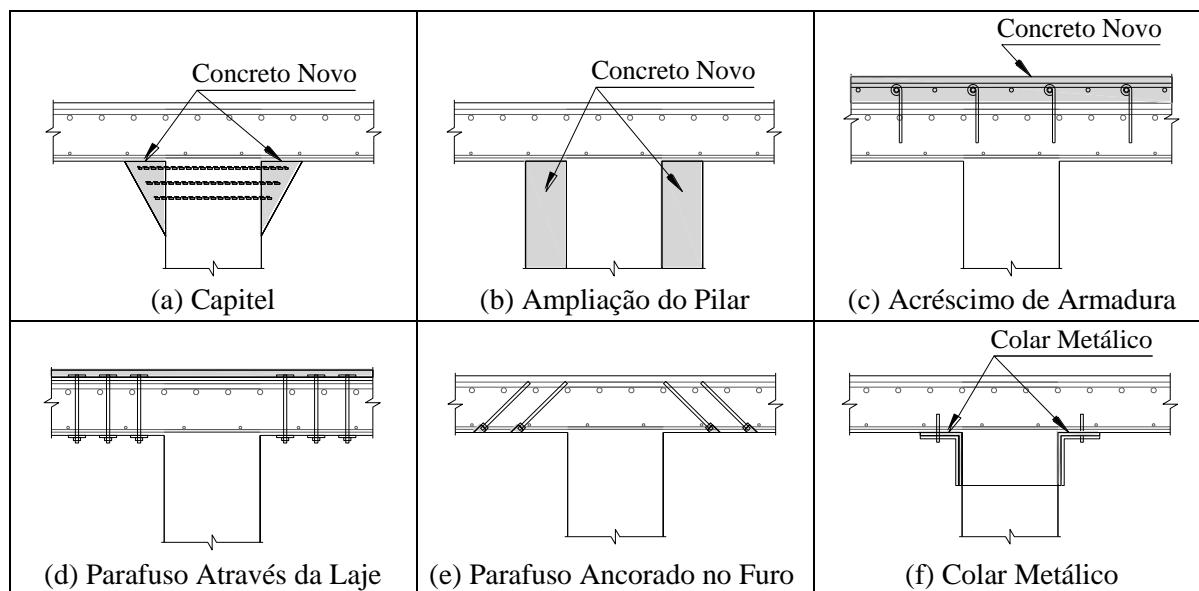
Soluções típicas para reforço de uma ligação laje- pilar
